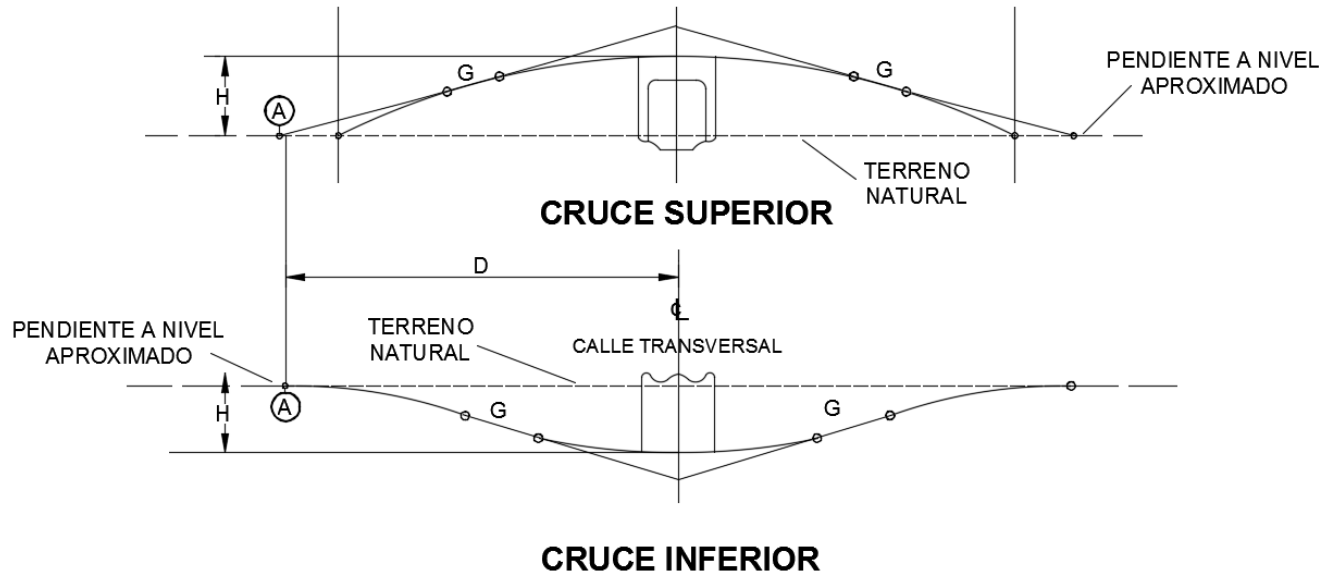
Distancia horizontal para alcanzar la altura requerida en pasos superiores e inferiores, en terreno plano
